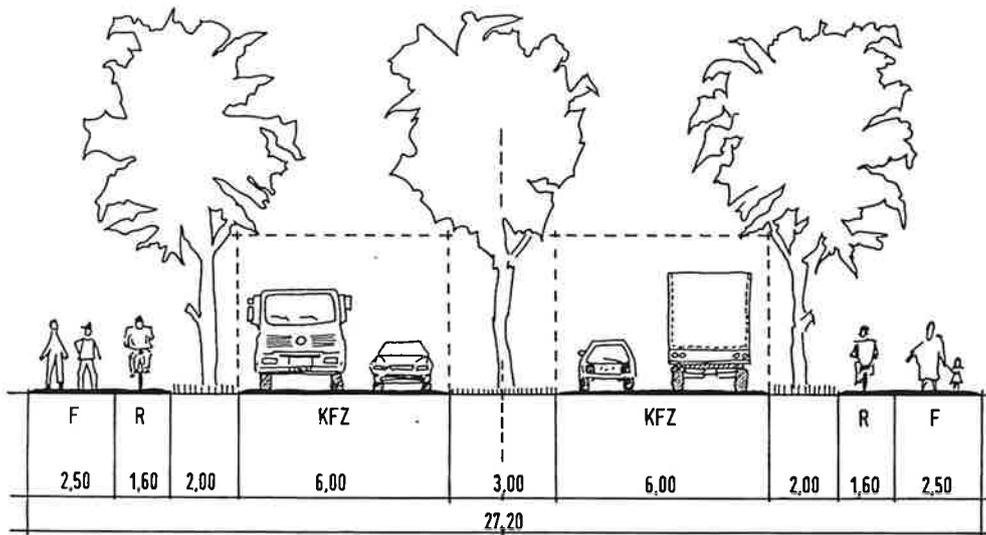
HAUPTSAMMELSTRASSE, ERNST-SCHNELLER-STRASSE, A₂-A₂
